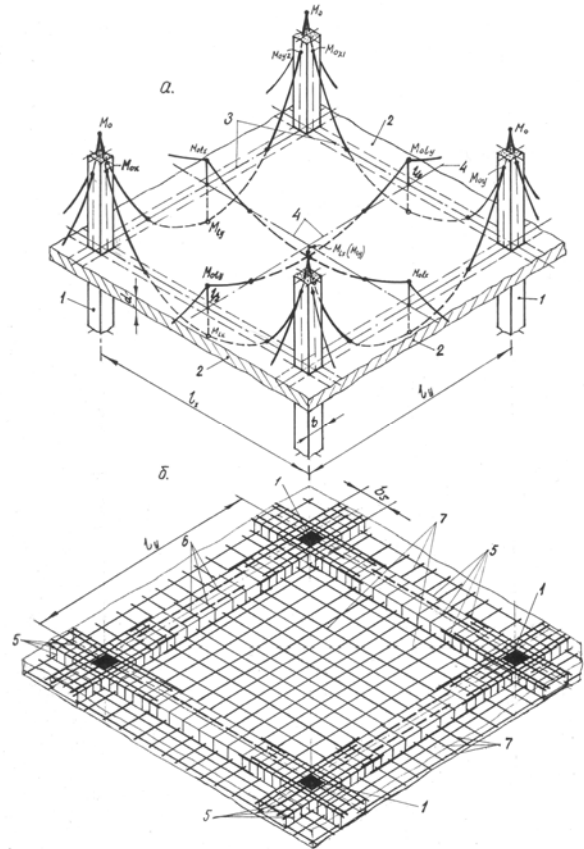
Принципова схема об'ємного армування плити плоского перекриття багатоповислової будівлі: а – загальний вигляд осередку фрагмента каркаса і розподіл згинальних моментів в перерізах плити перекриття, б – схема об'ємного армування плити;
